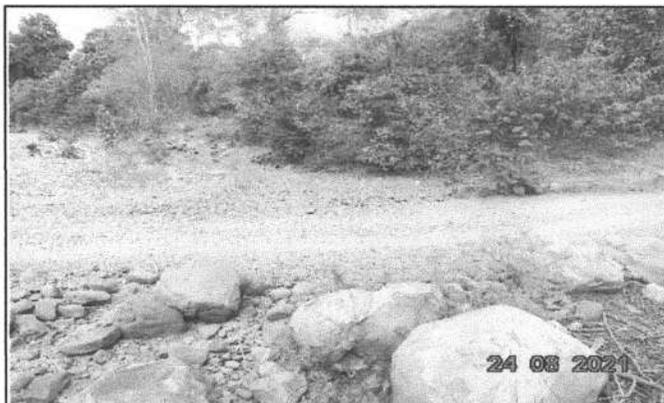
LOCAL DA CONSTRUÇÃO- BUEIRO
